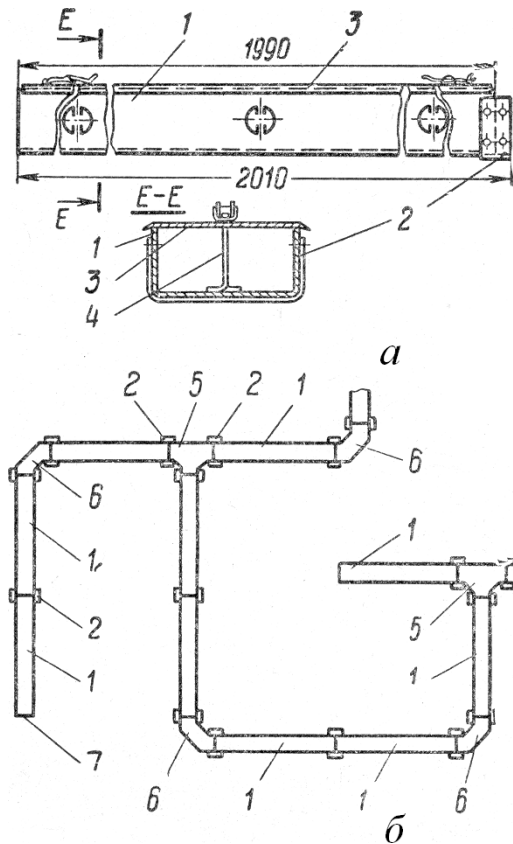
Короб для прокладки проводов и кабелей: а — короб однопанельный; б — пример сборки коробов; 1 — короб; 2 — обойма съемная; 3 — крышка сварная; 4 — уголок; 5 — тройник; 6 — уголок универсальный; 7 — крышка торцевая
